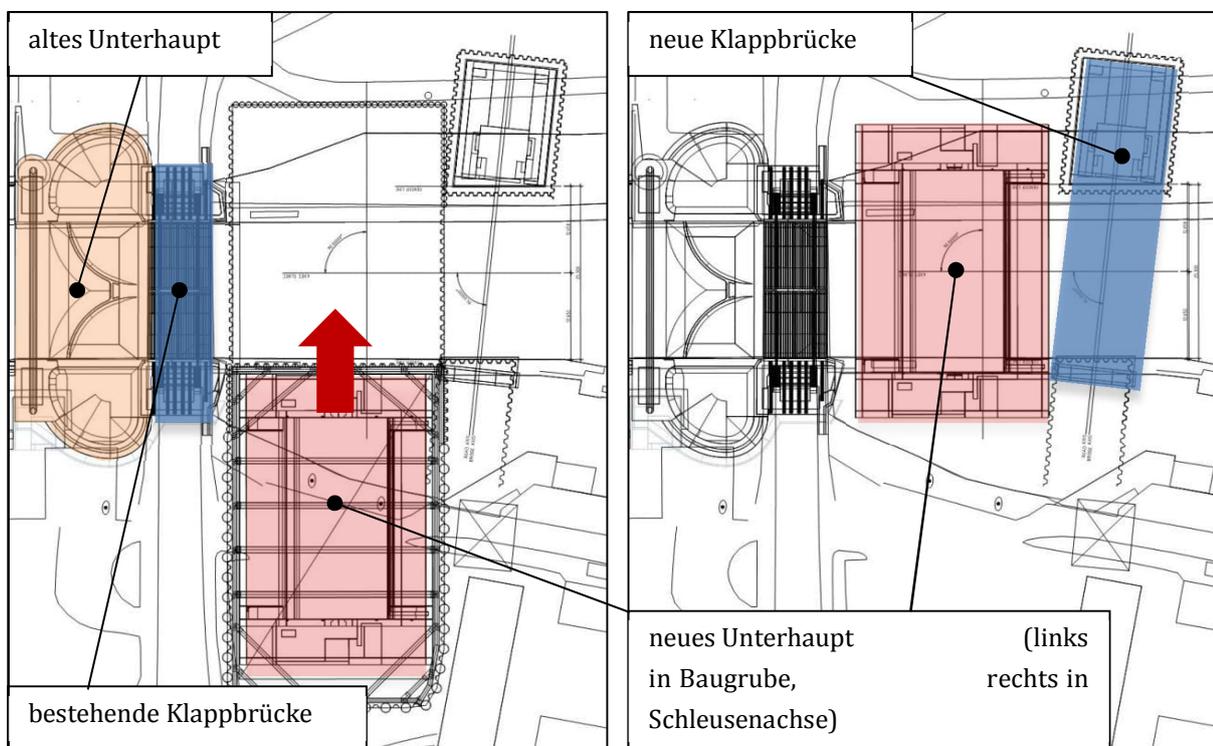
Lageplan mit altem und neuem Unterhaupt und Klappbrücken
